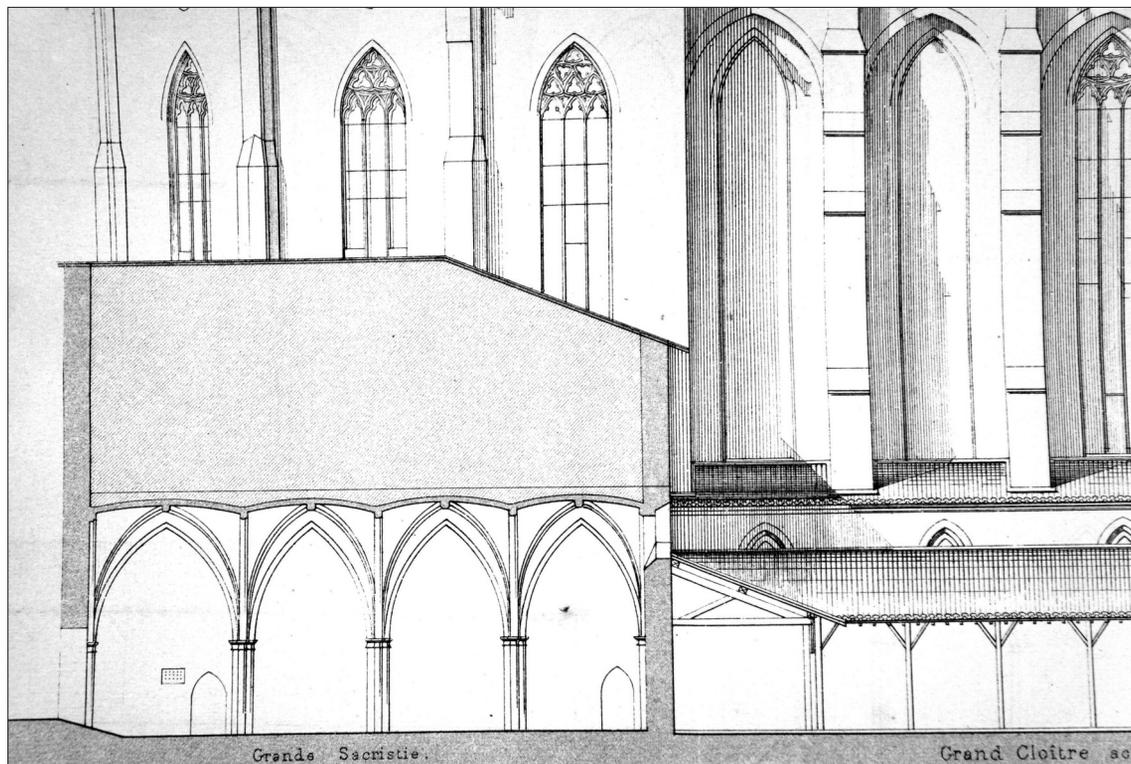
COUPE SUR LA SACRISTIE et le cloître, 1876, planche 3, détail. *Relevé de J.-J. Esquié.
